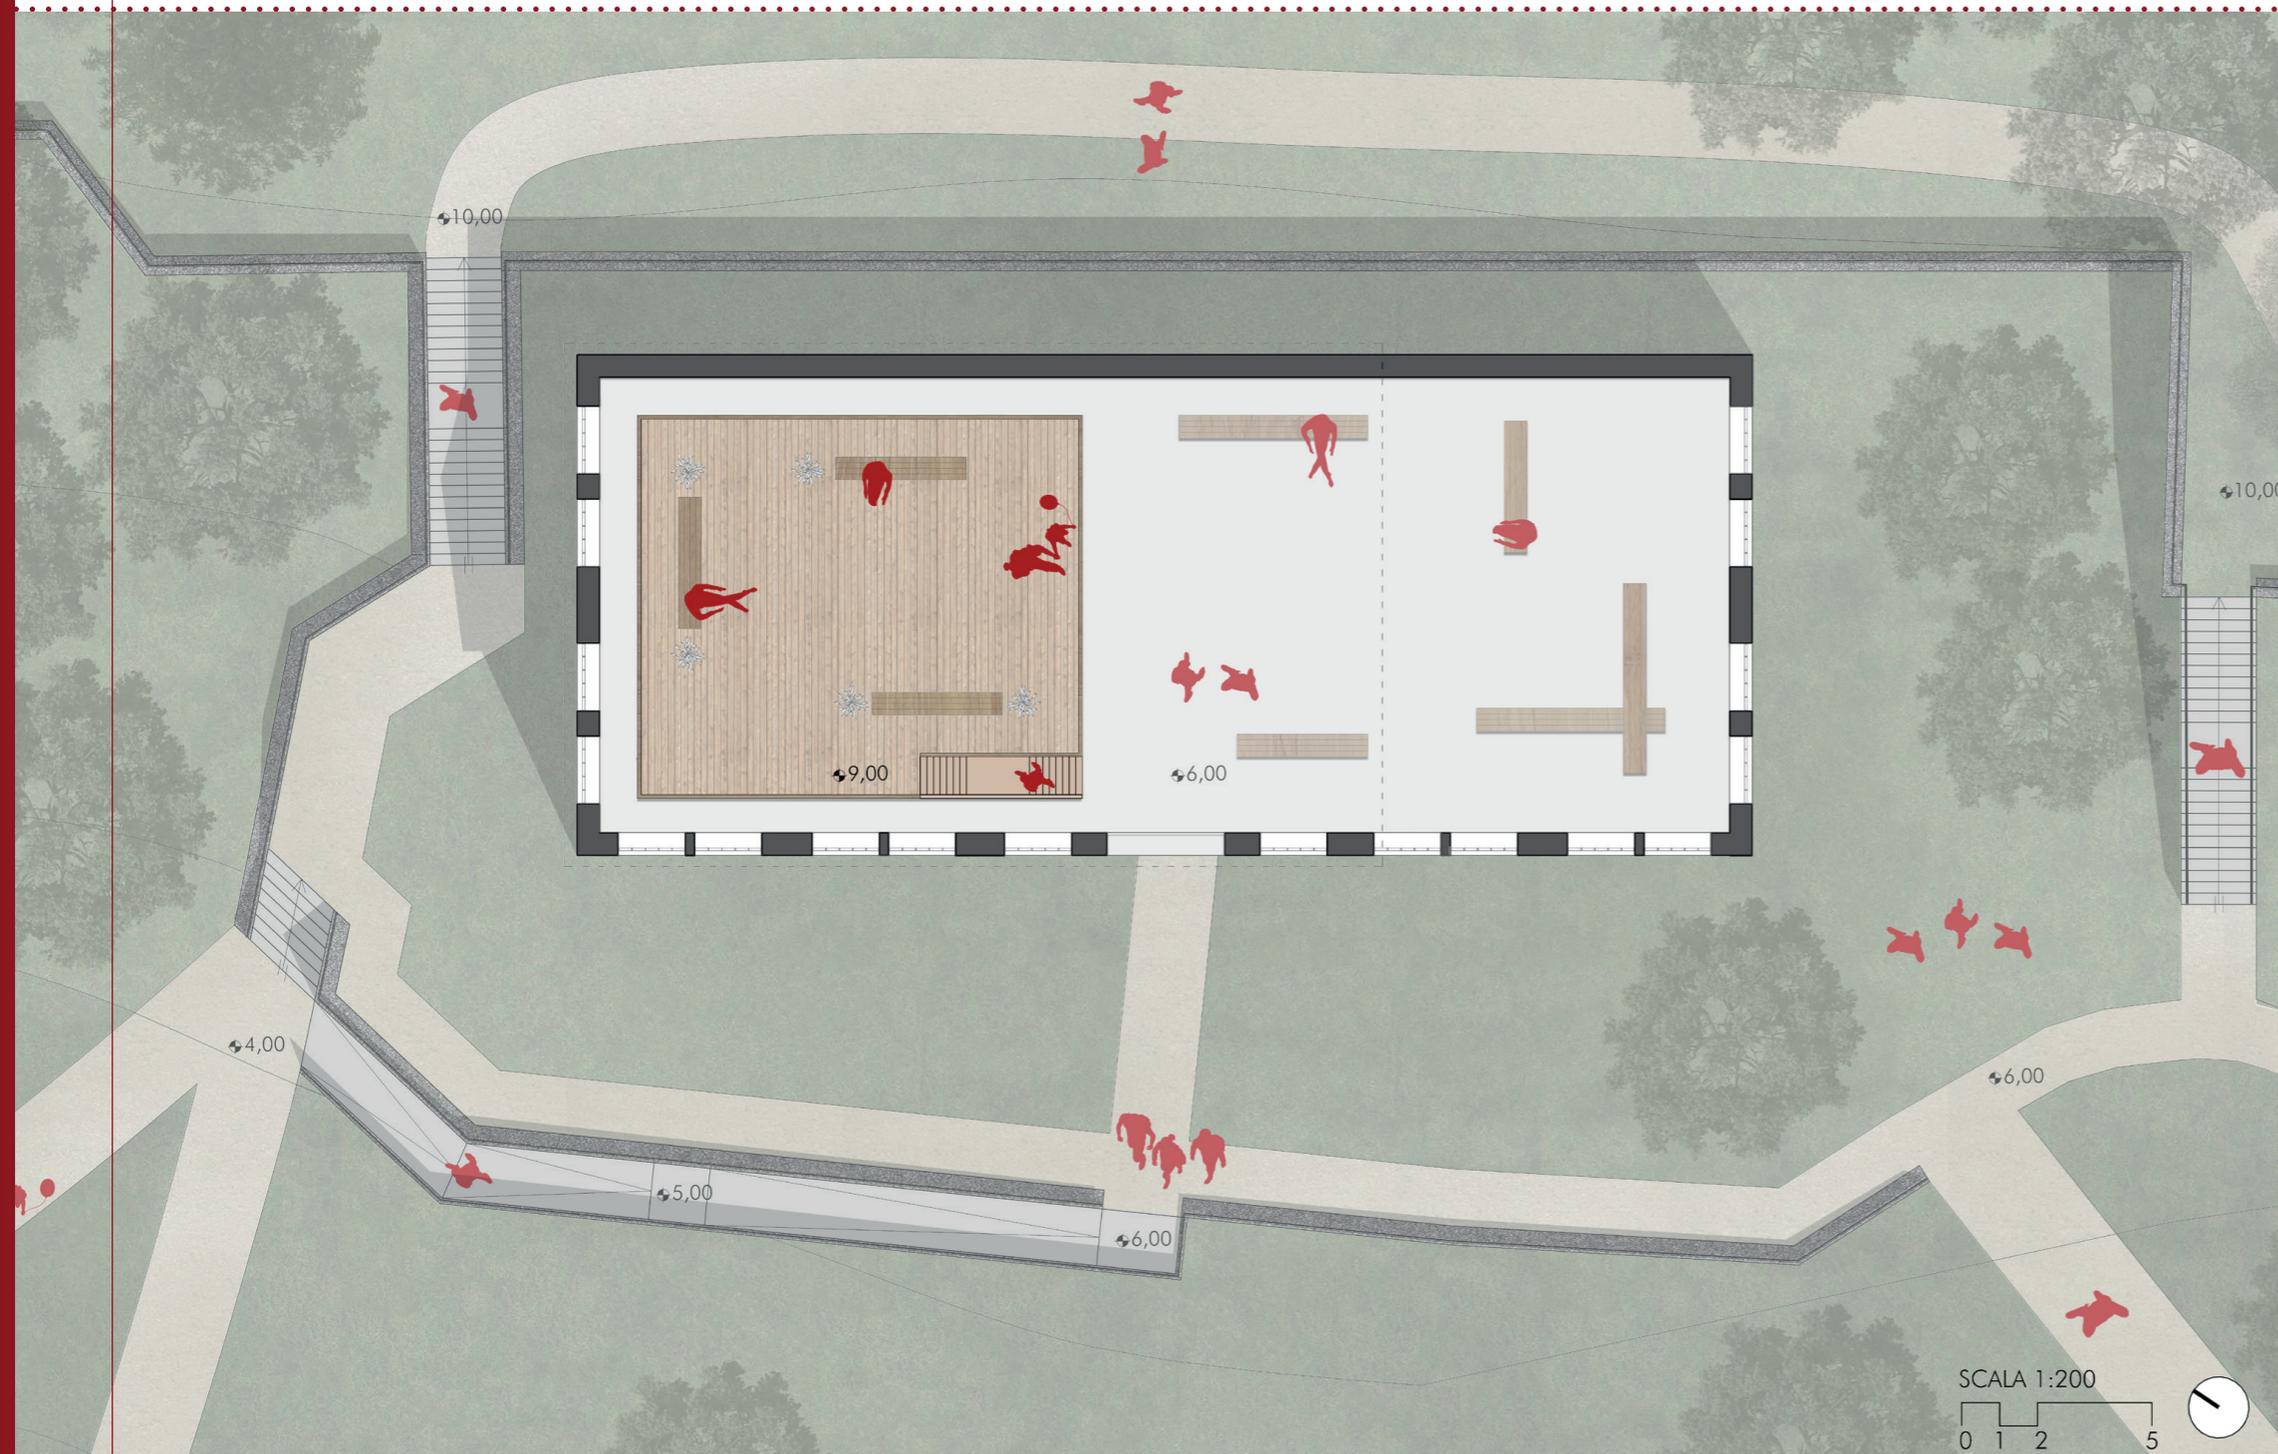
Pianta del piano primo del polo centrale dell'escape room, elaborazione delle autrici
